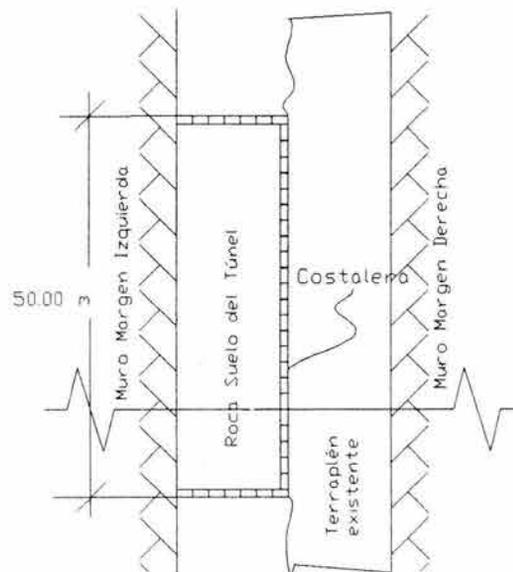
Vista en planta, Detalle de la Preplantilla de Relleno (Reposición de roca) y Plantilla Definitiva.
